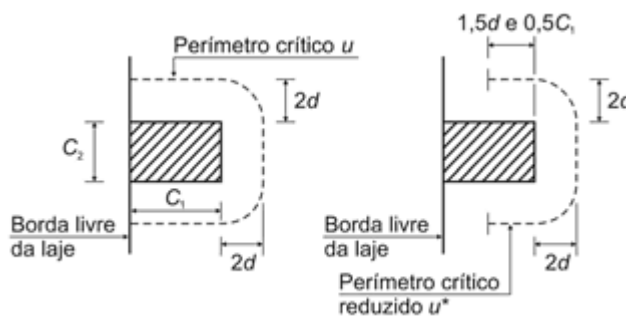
Perímetro crítico na face do pilar de bordo (C)
